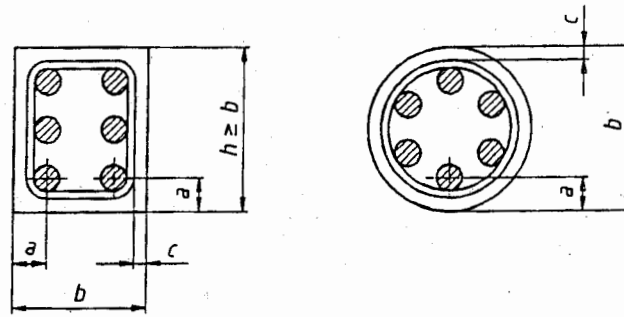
Bauteilquerschnitte mit Achsabstand a und Betondeckung c der Bewehrung (Nennmaße).
